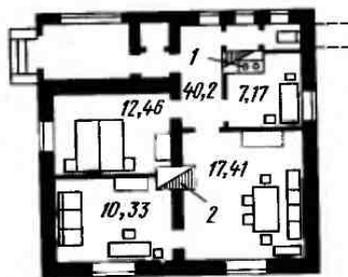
План одноэтажного одноквартирного дома с печным отоплением:
